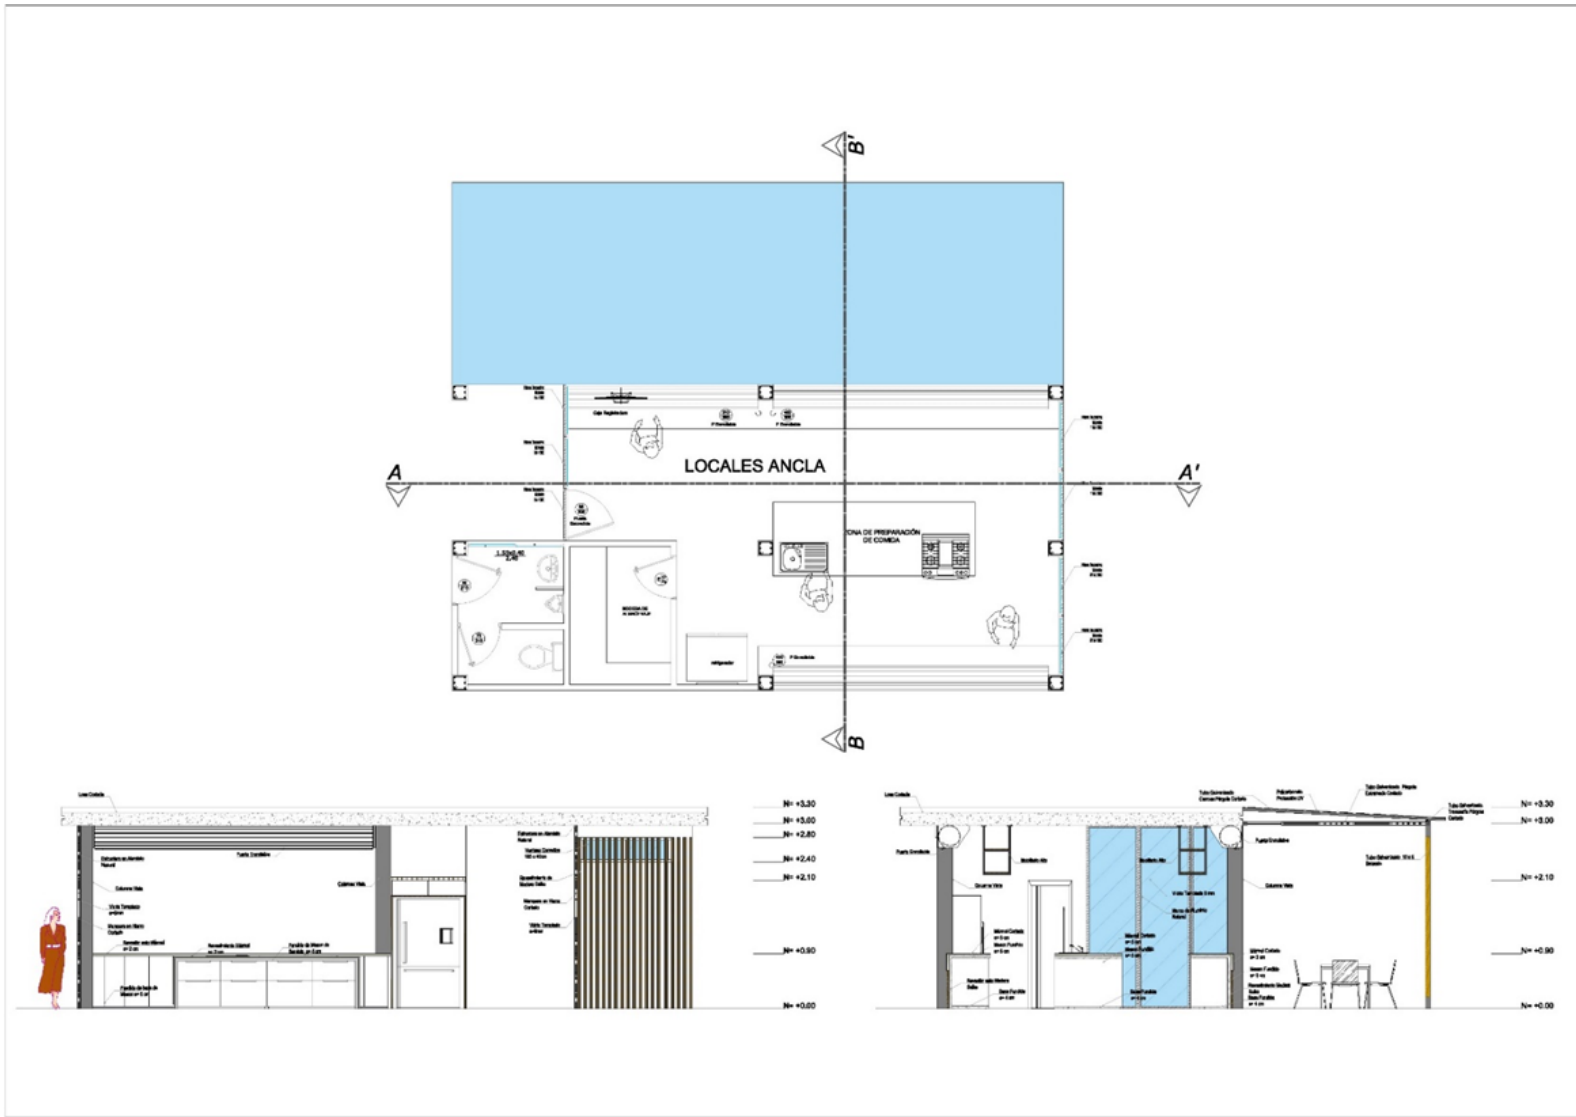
Detalle en Anexo 14. Elaboración: Propia.
